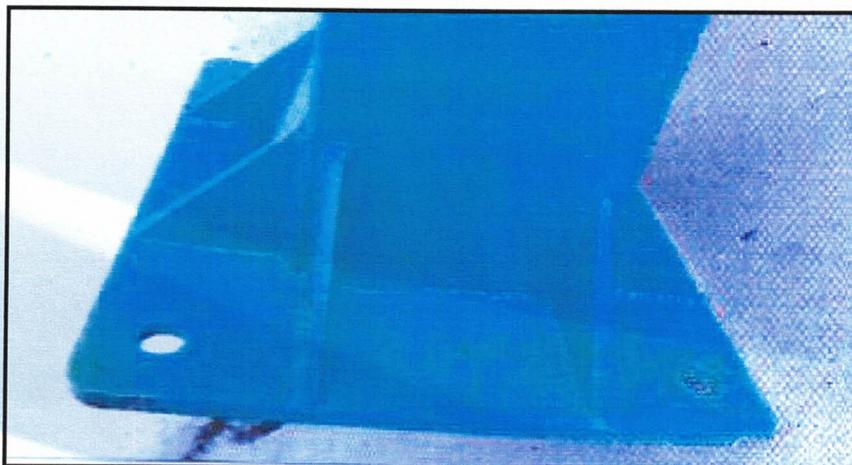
Foto da base da coluna da estrutura de sustentação.
